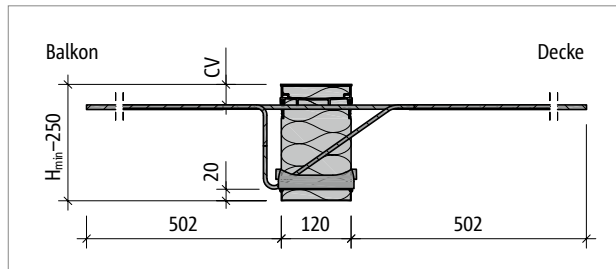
Schöck Isokorb® XT Typ K-M1 bis M4 bei R0: Produktschnitt
